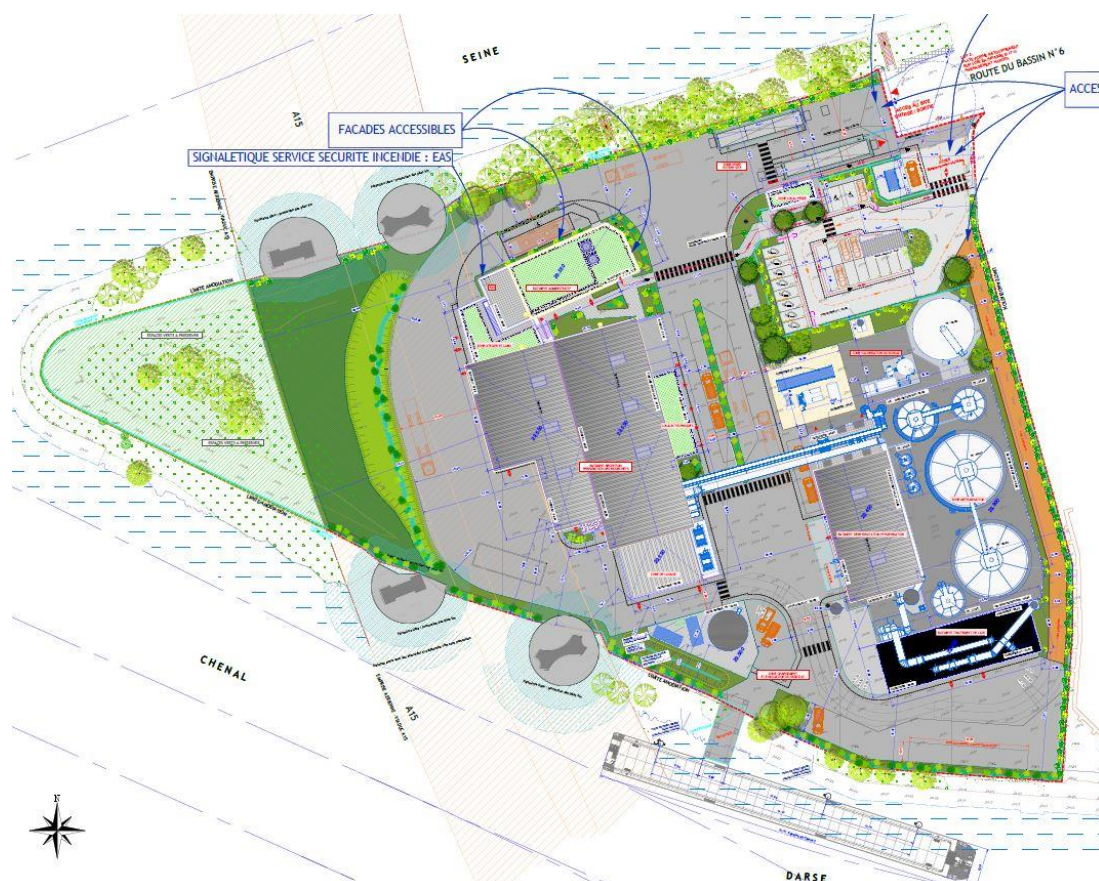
Plan d'implantation du site (source : SEPOC.2023)
